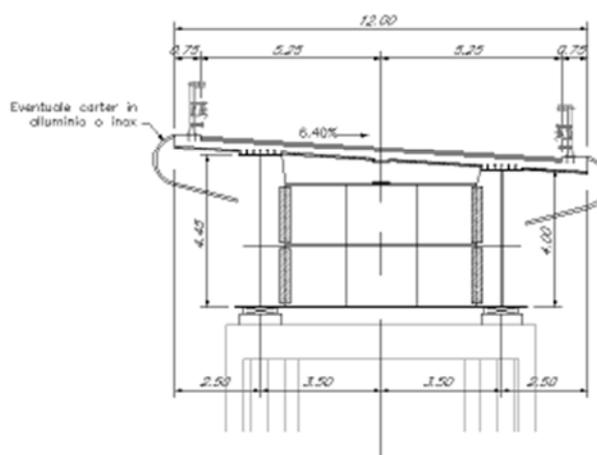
Sezioni trasversali tipo in asse alle pile e corrente
